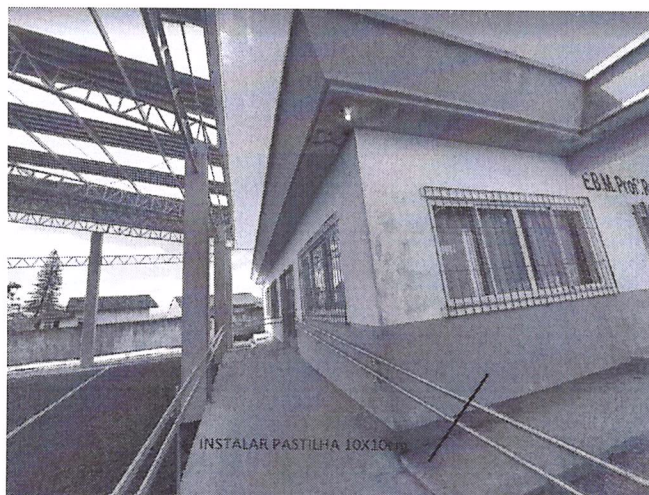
Fachada da escola com faixa que contorna toda a escola onde serão instaladas as pastilhas
